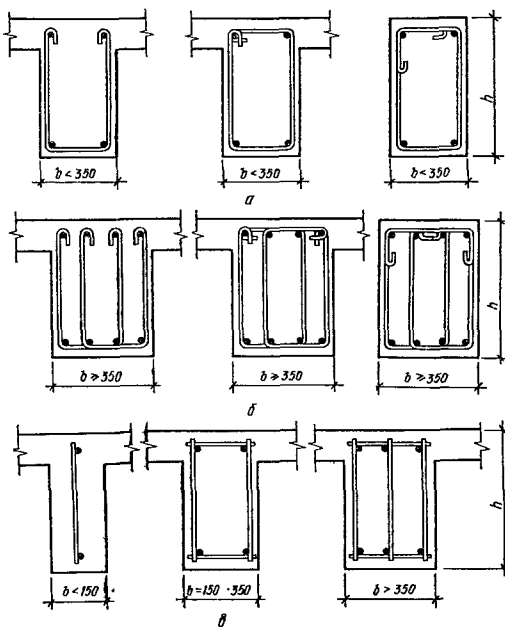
Схемы армирования сечений балок: а — вязаной арматурой, двухсрезными хомутами; б — то же, четырехсрезными хомутами; в — сварной арматурой
